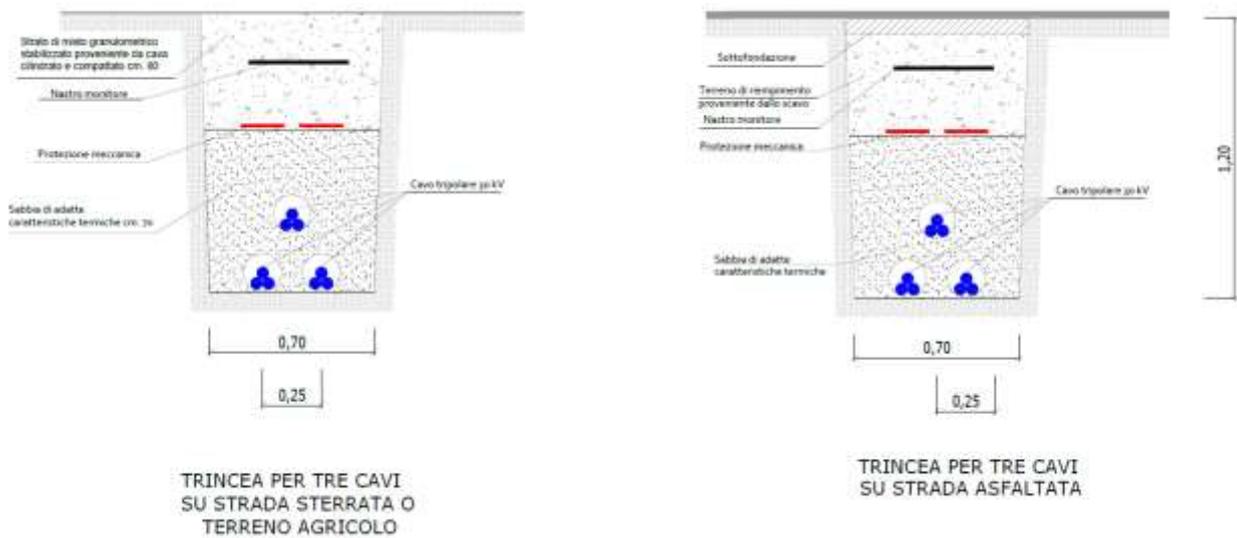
Sezione della trincea di scavo per la posa di n. 3 cavi da 30kV di collegamento dall’impianto FV alla Stazione di Elevazione – su strada sterrata o terreno agricolo e su strada asfaltata
